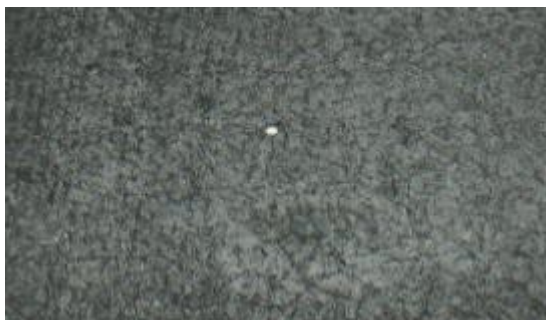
Desconchamiento / Mapa de grietas / Craquelado de baja severidad.
